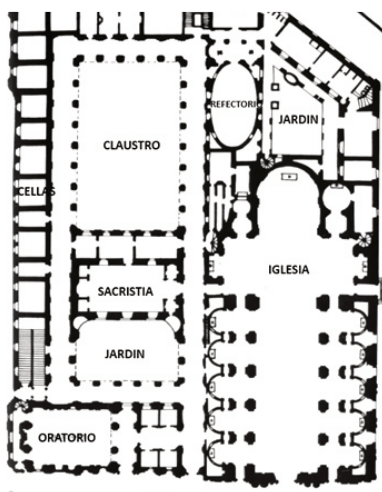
Detalle plano de la planta oratorio San Felipe Neri de Roma.
